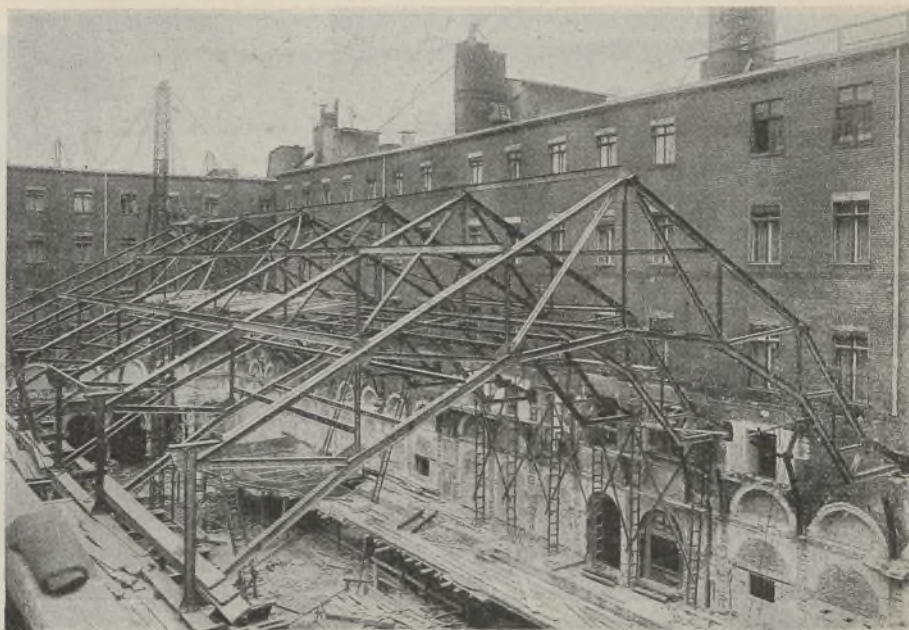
Die neue Stahlkonstruktion des Glasdaches über dem Zuschauerraum.
